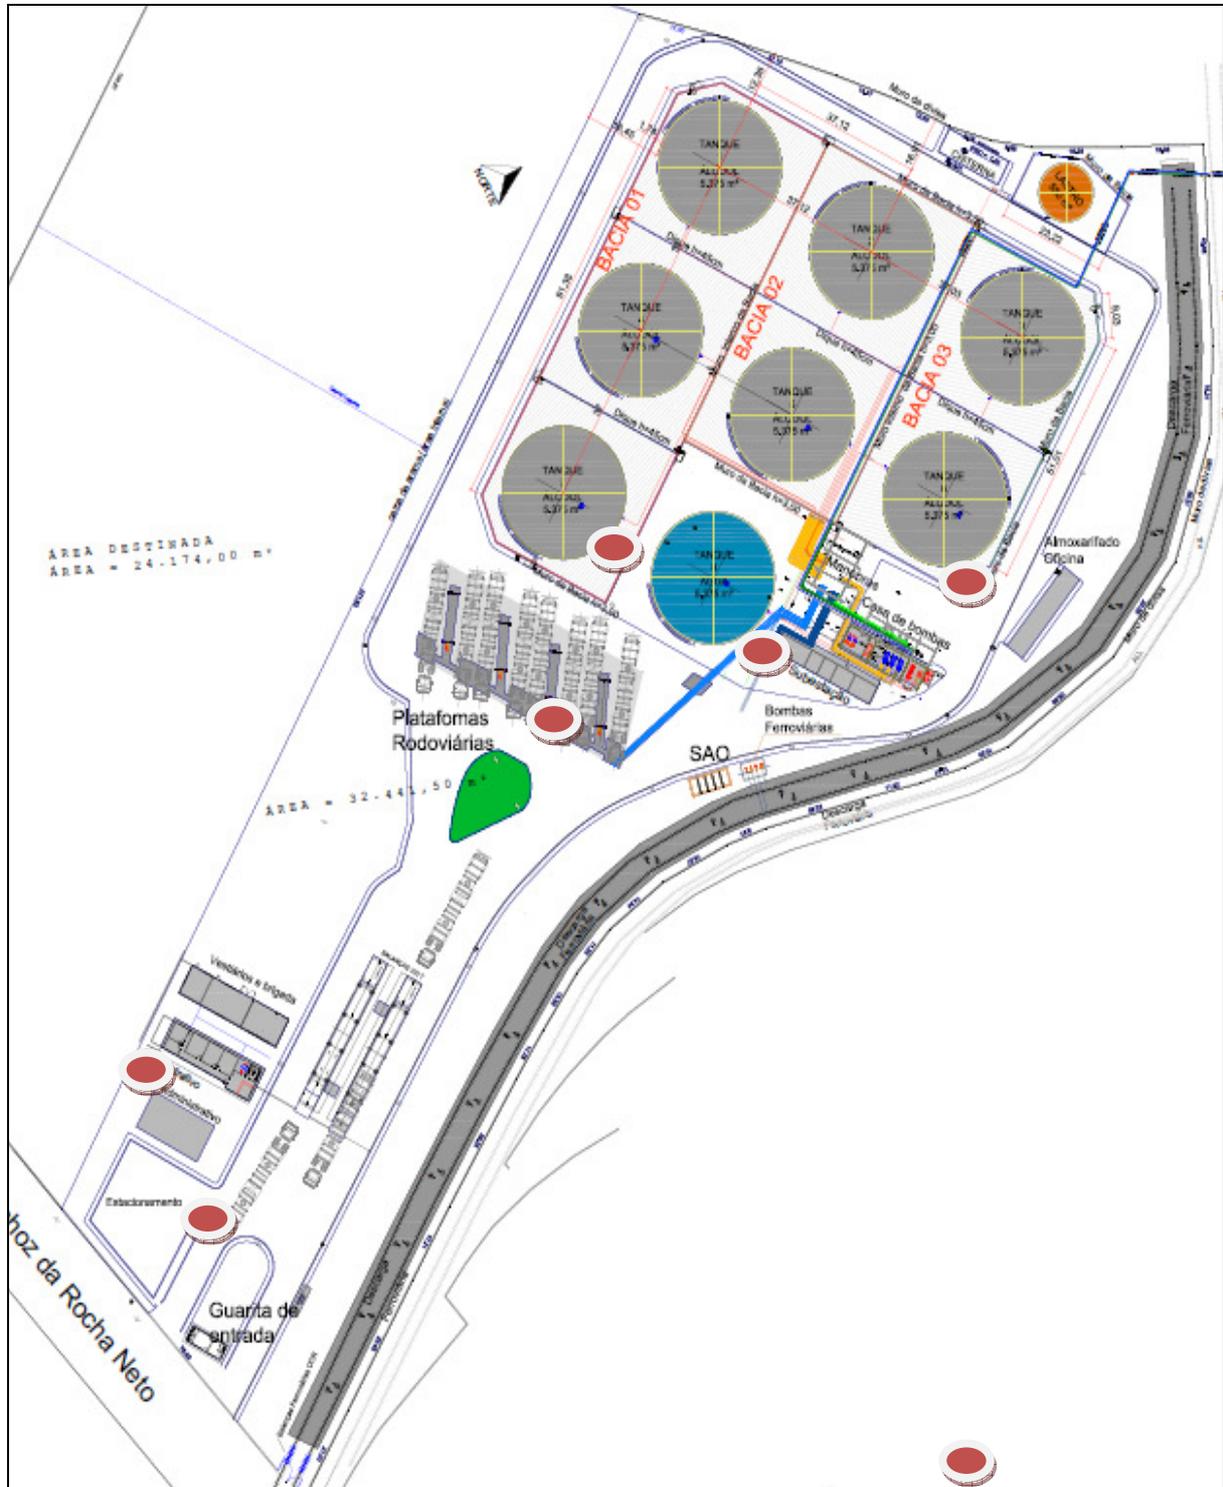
Lay out e pontos de restrições de acesso. ()
